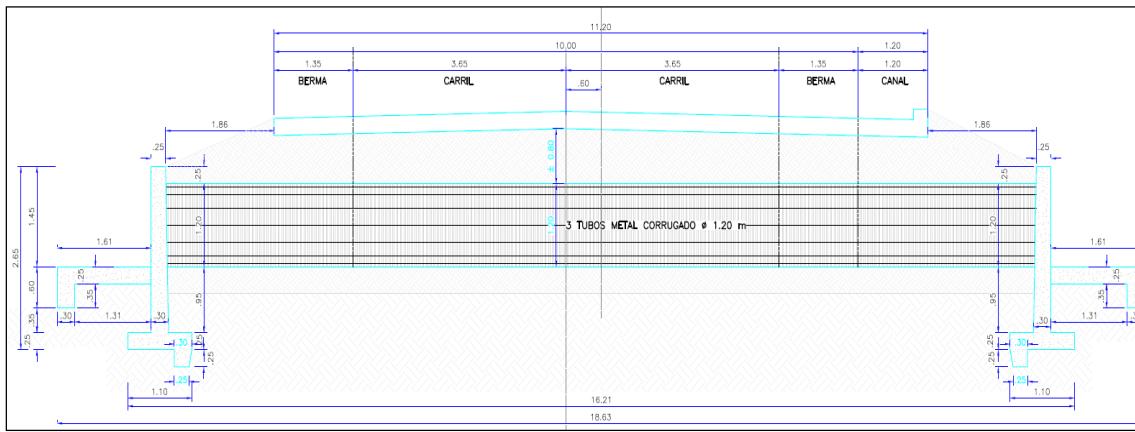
Planos de diseño de planta Box Culvert corte B-B para la obra de drenaje PR81+190
